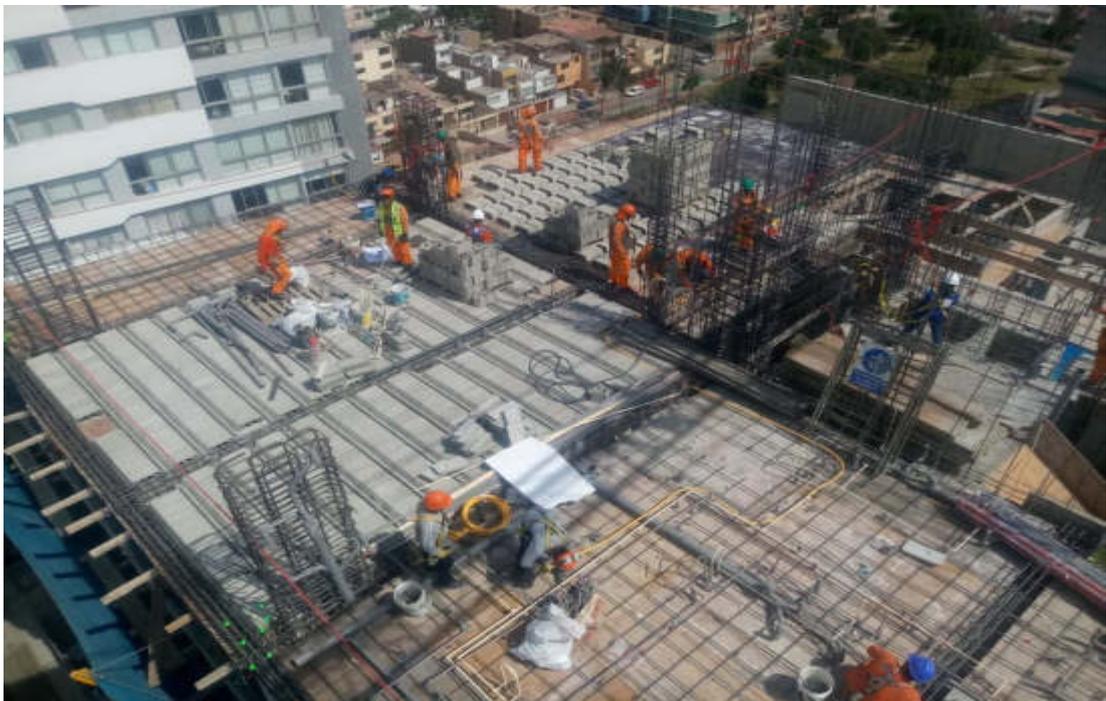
Colocación de encofrado en placas por la empresa contratista H C edificaciones.
